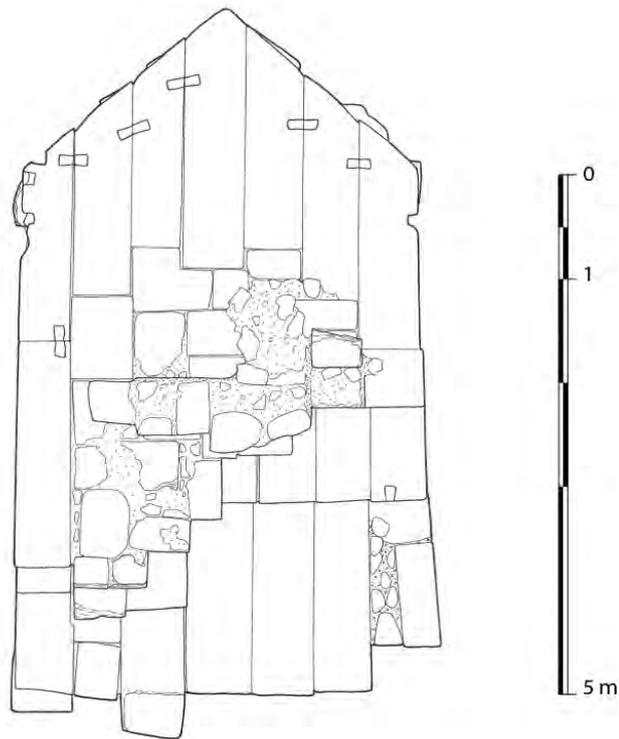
Plan et élévation de la pile centrale du pont-barrage, telle que dégagée en 1986
